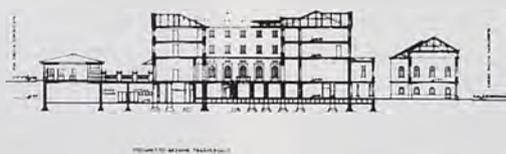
g - Il progetto di ristrutturazione: sezione trasversale.
